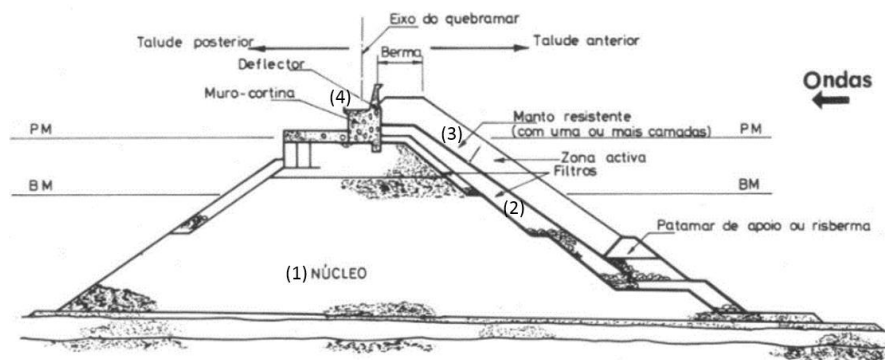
Constituição do perfil corrente de um quebra-mar de talude (Pita, 1986).
